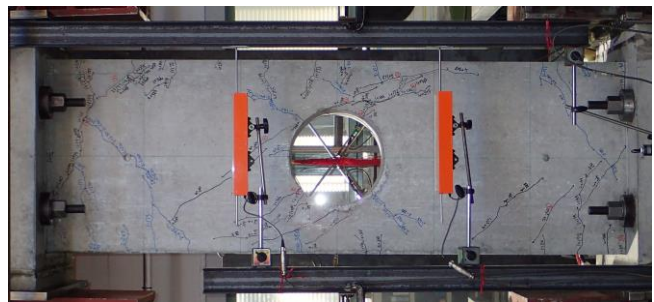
試験体の最大耐力時ひび割れ状況
